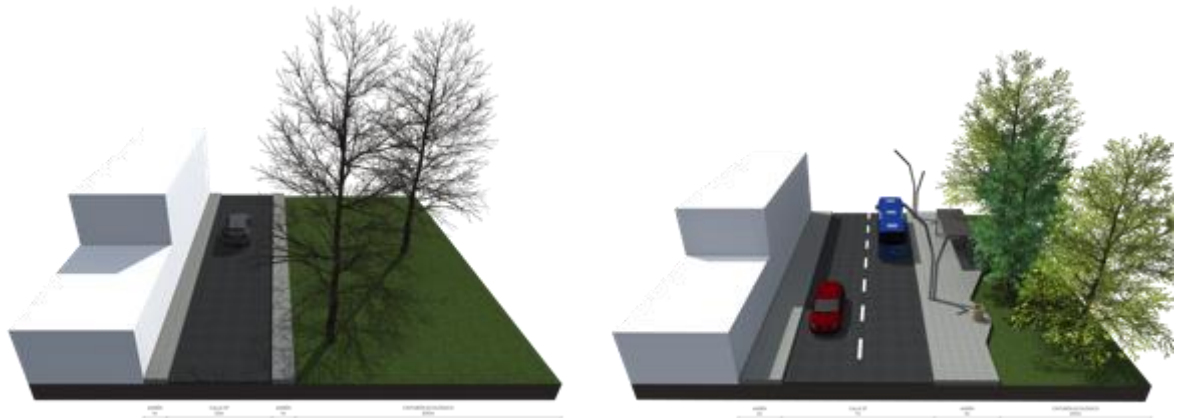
Perfil Vial calle 57 Estado actual / Propuesta - Elaborado por los autores
